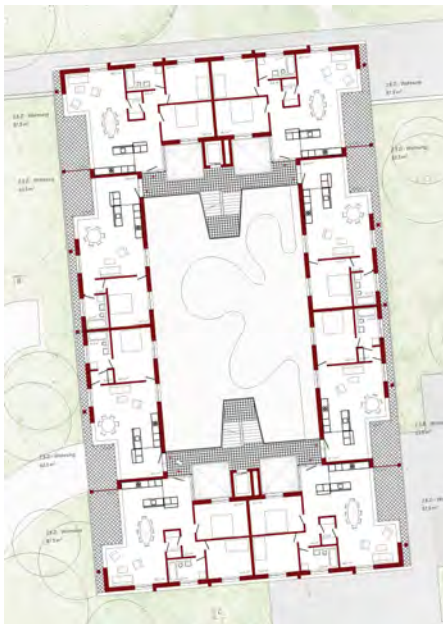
Alice &amp; Ellen: Grundriss Regelgeschoss Wohnbau
